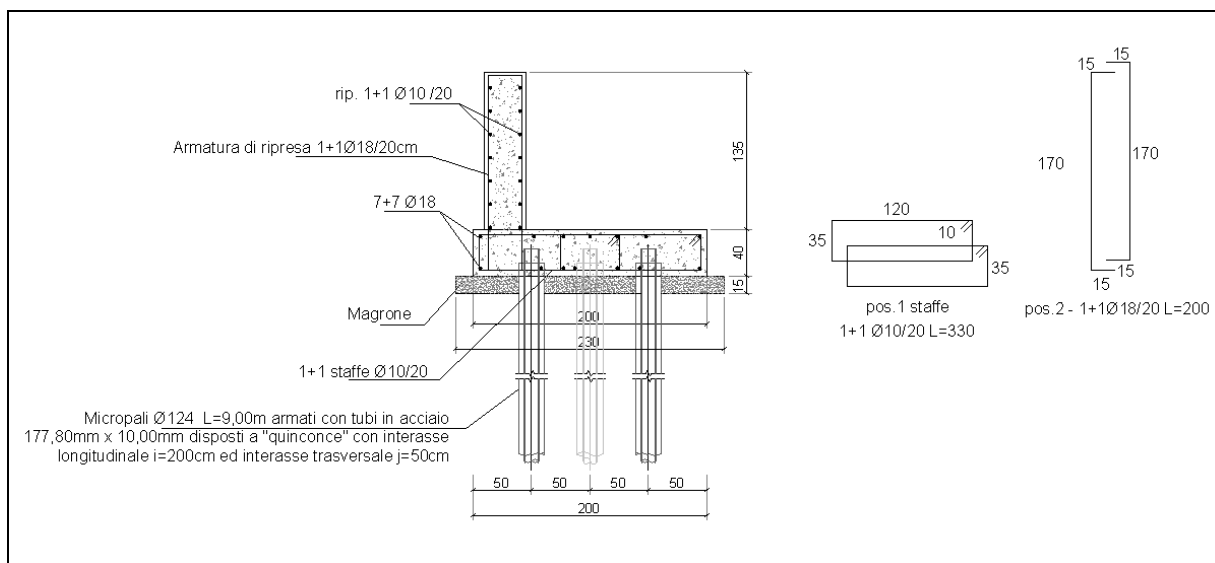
Sezione trasversale del muro di altezza minore $h_{\min}=135$ cm
